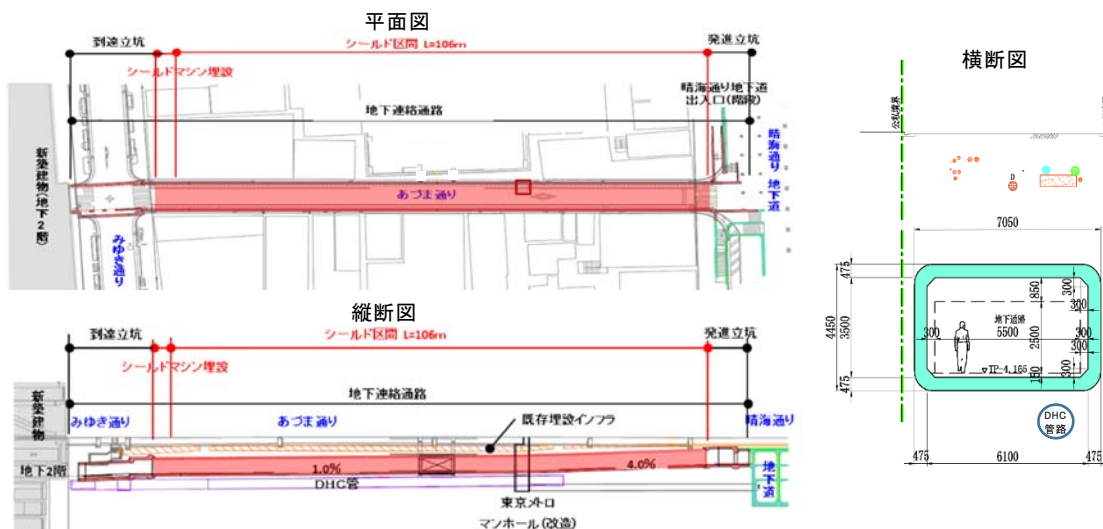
銀座六丁目地下連絡通路整備工事 平面図・縦断図・横断図
